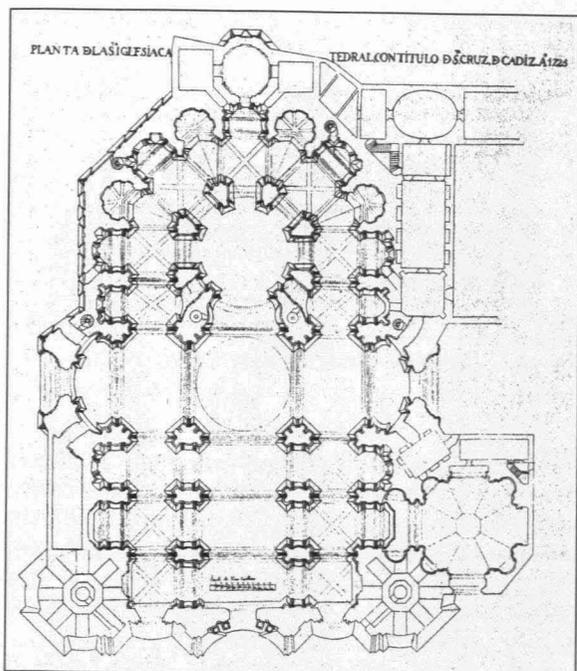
Catedral de Cádiz. Planta de 1725 sobre el calco de Pablo Gutiérrez Moreno (1928).
